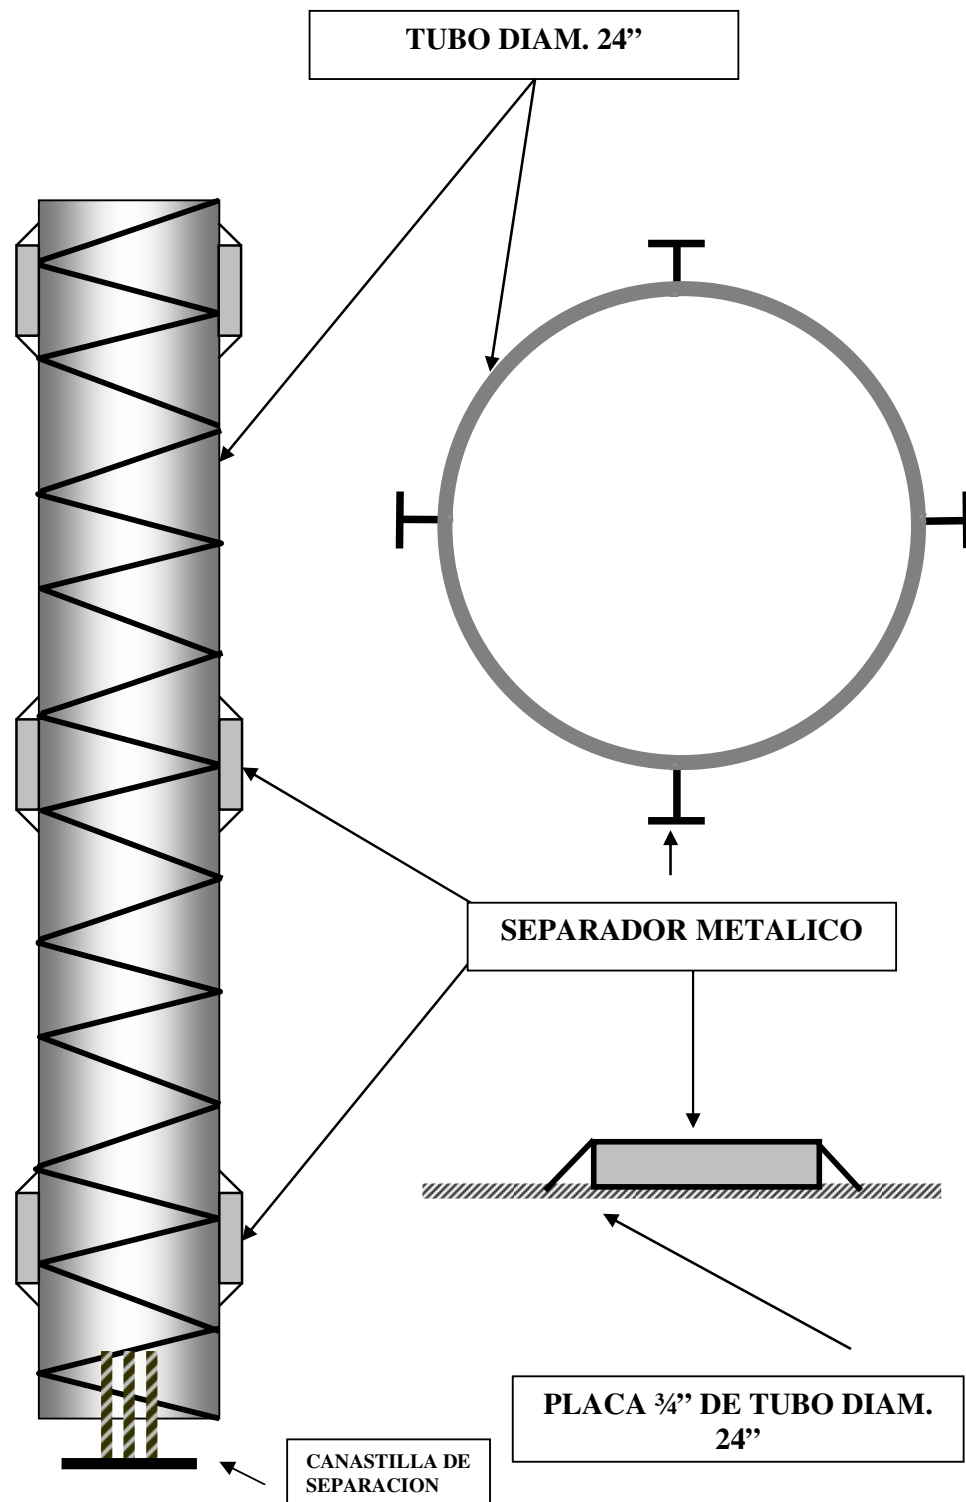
COLOCACIÓN DE SEPARADORES Y CENTRADORES EN PIN PILE.
